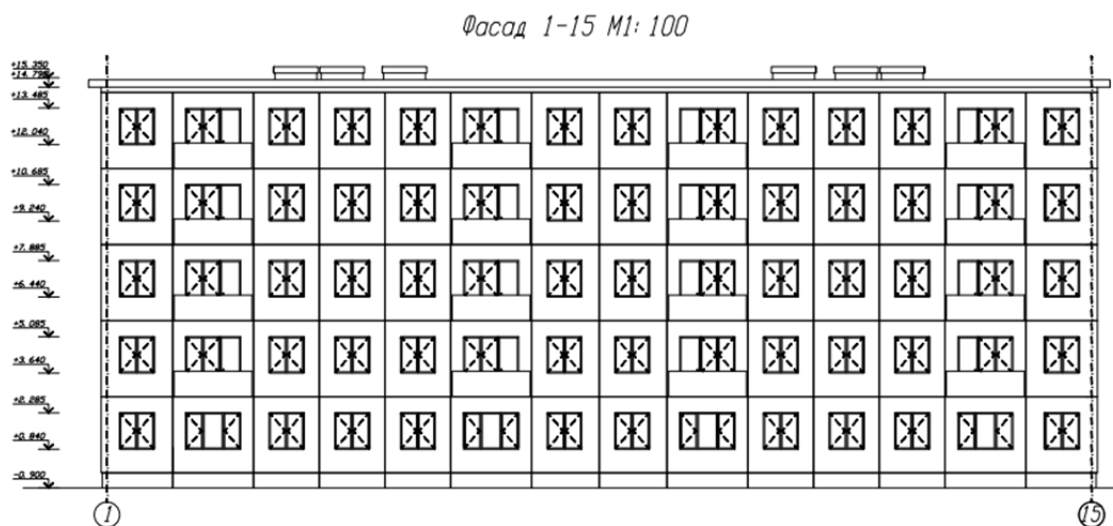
Фасад 1-15 жилого дома типовой серии 1-464
